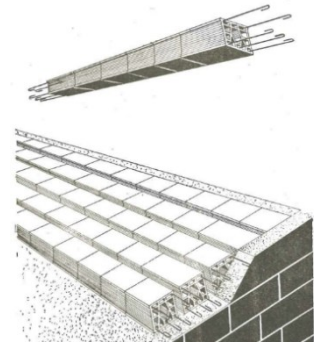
posa in opera dei travetti armati di un solaio "SAP" (fonte: "Solai soffitti coperti, nella moderna edilizia", di Edmondo Protti)
